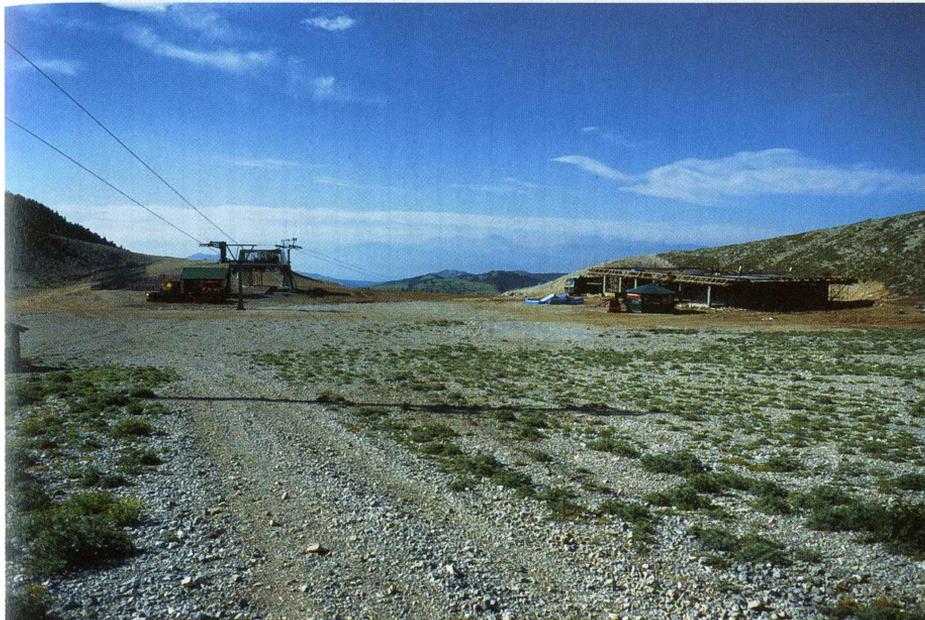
Skilift und im Bau befindliches Gasthaus an großflächig planierter Skipiste. Hier wurden eingeschnittene Bachläufe zugeschüttet und eingeebnet (2.6.2001). Fotos: J Hölzinger.
